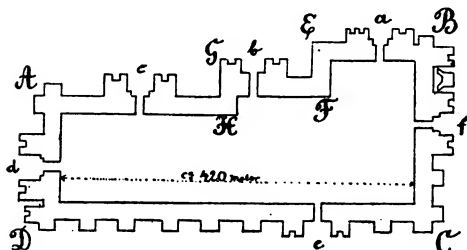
Grundriß der Festung des Gubea von Lagasch.
